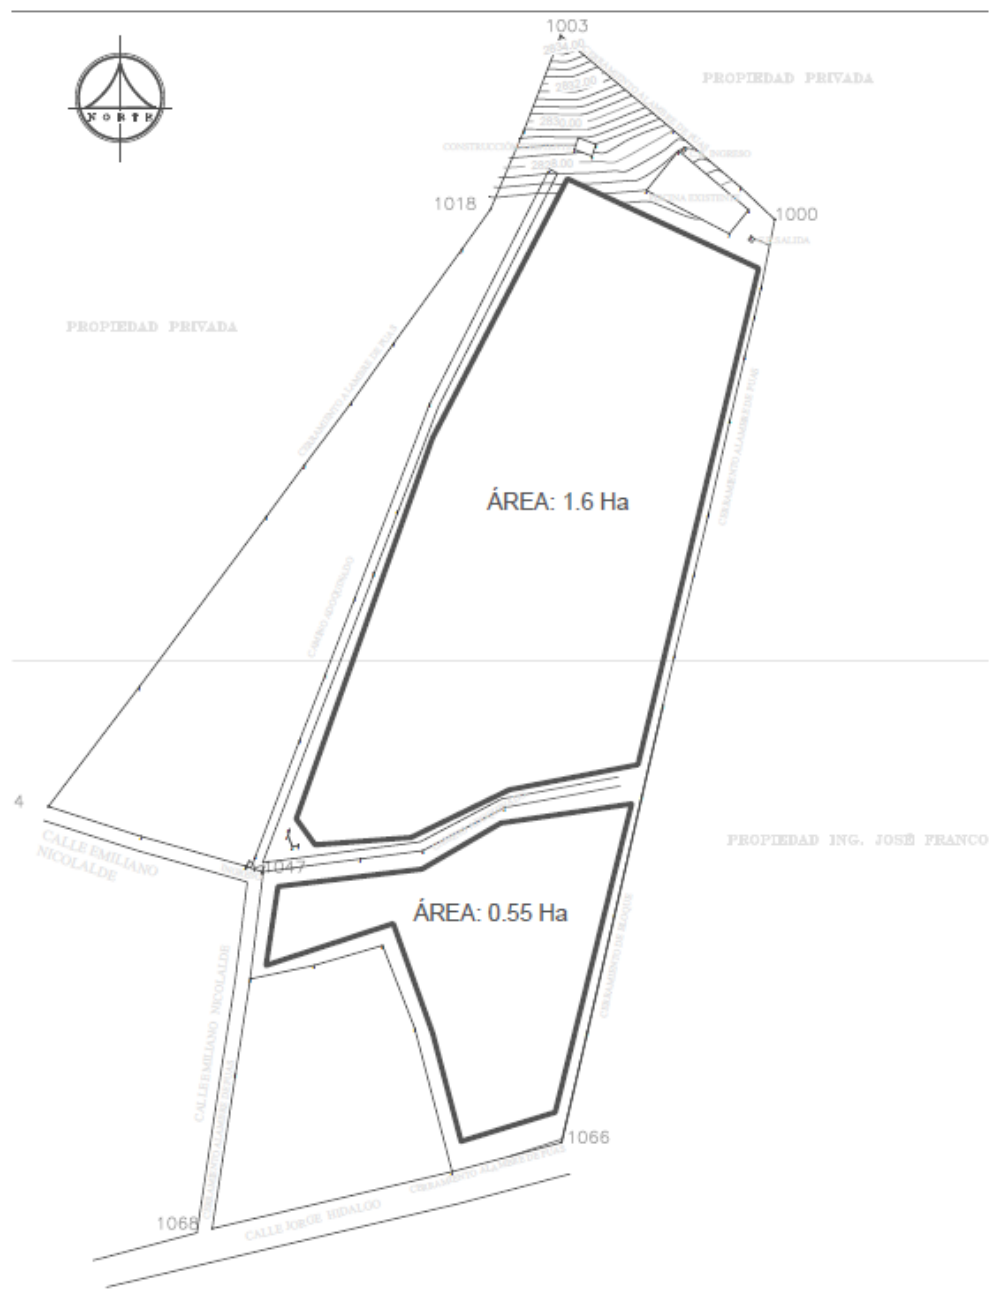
Áreas de terreno para diseño del sistema de riego por goteo
